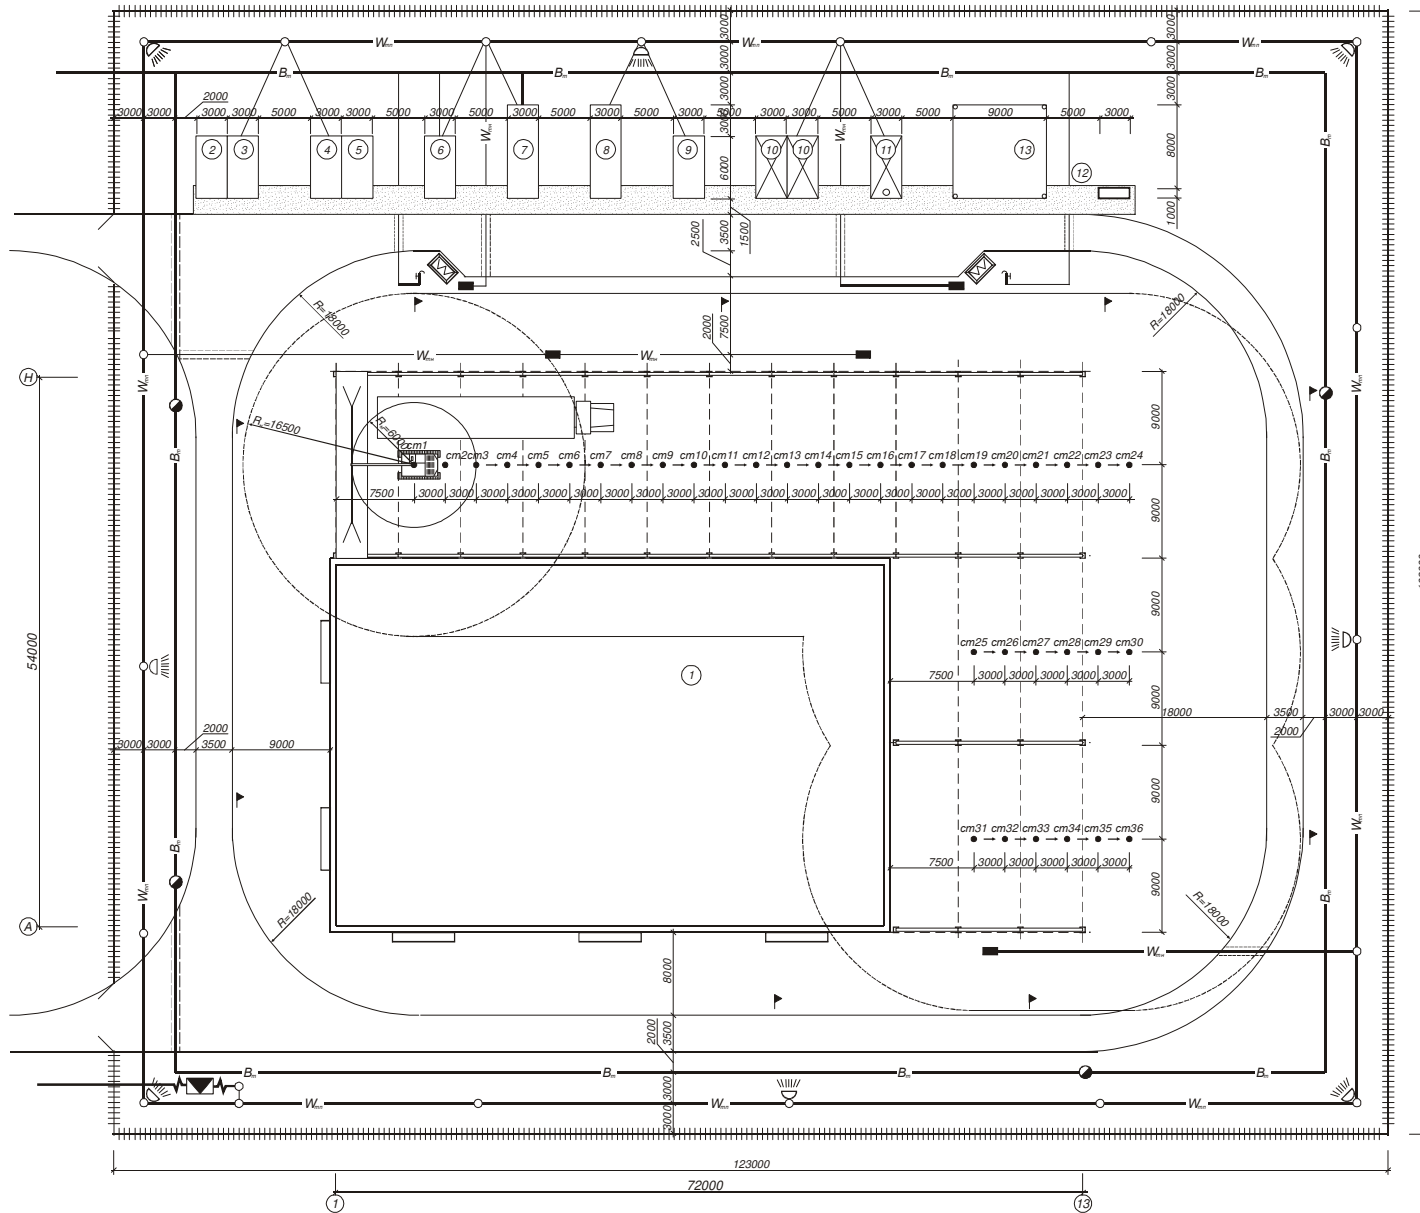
Будівельний генеральний план реконструкції одноповерхової виробничої будівлі
